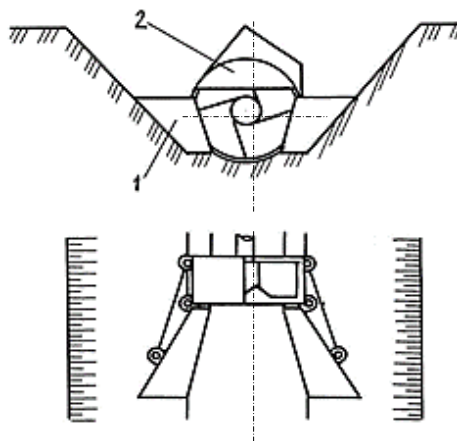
Схема фрезерного рабочего органа с открывками:
